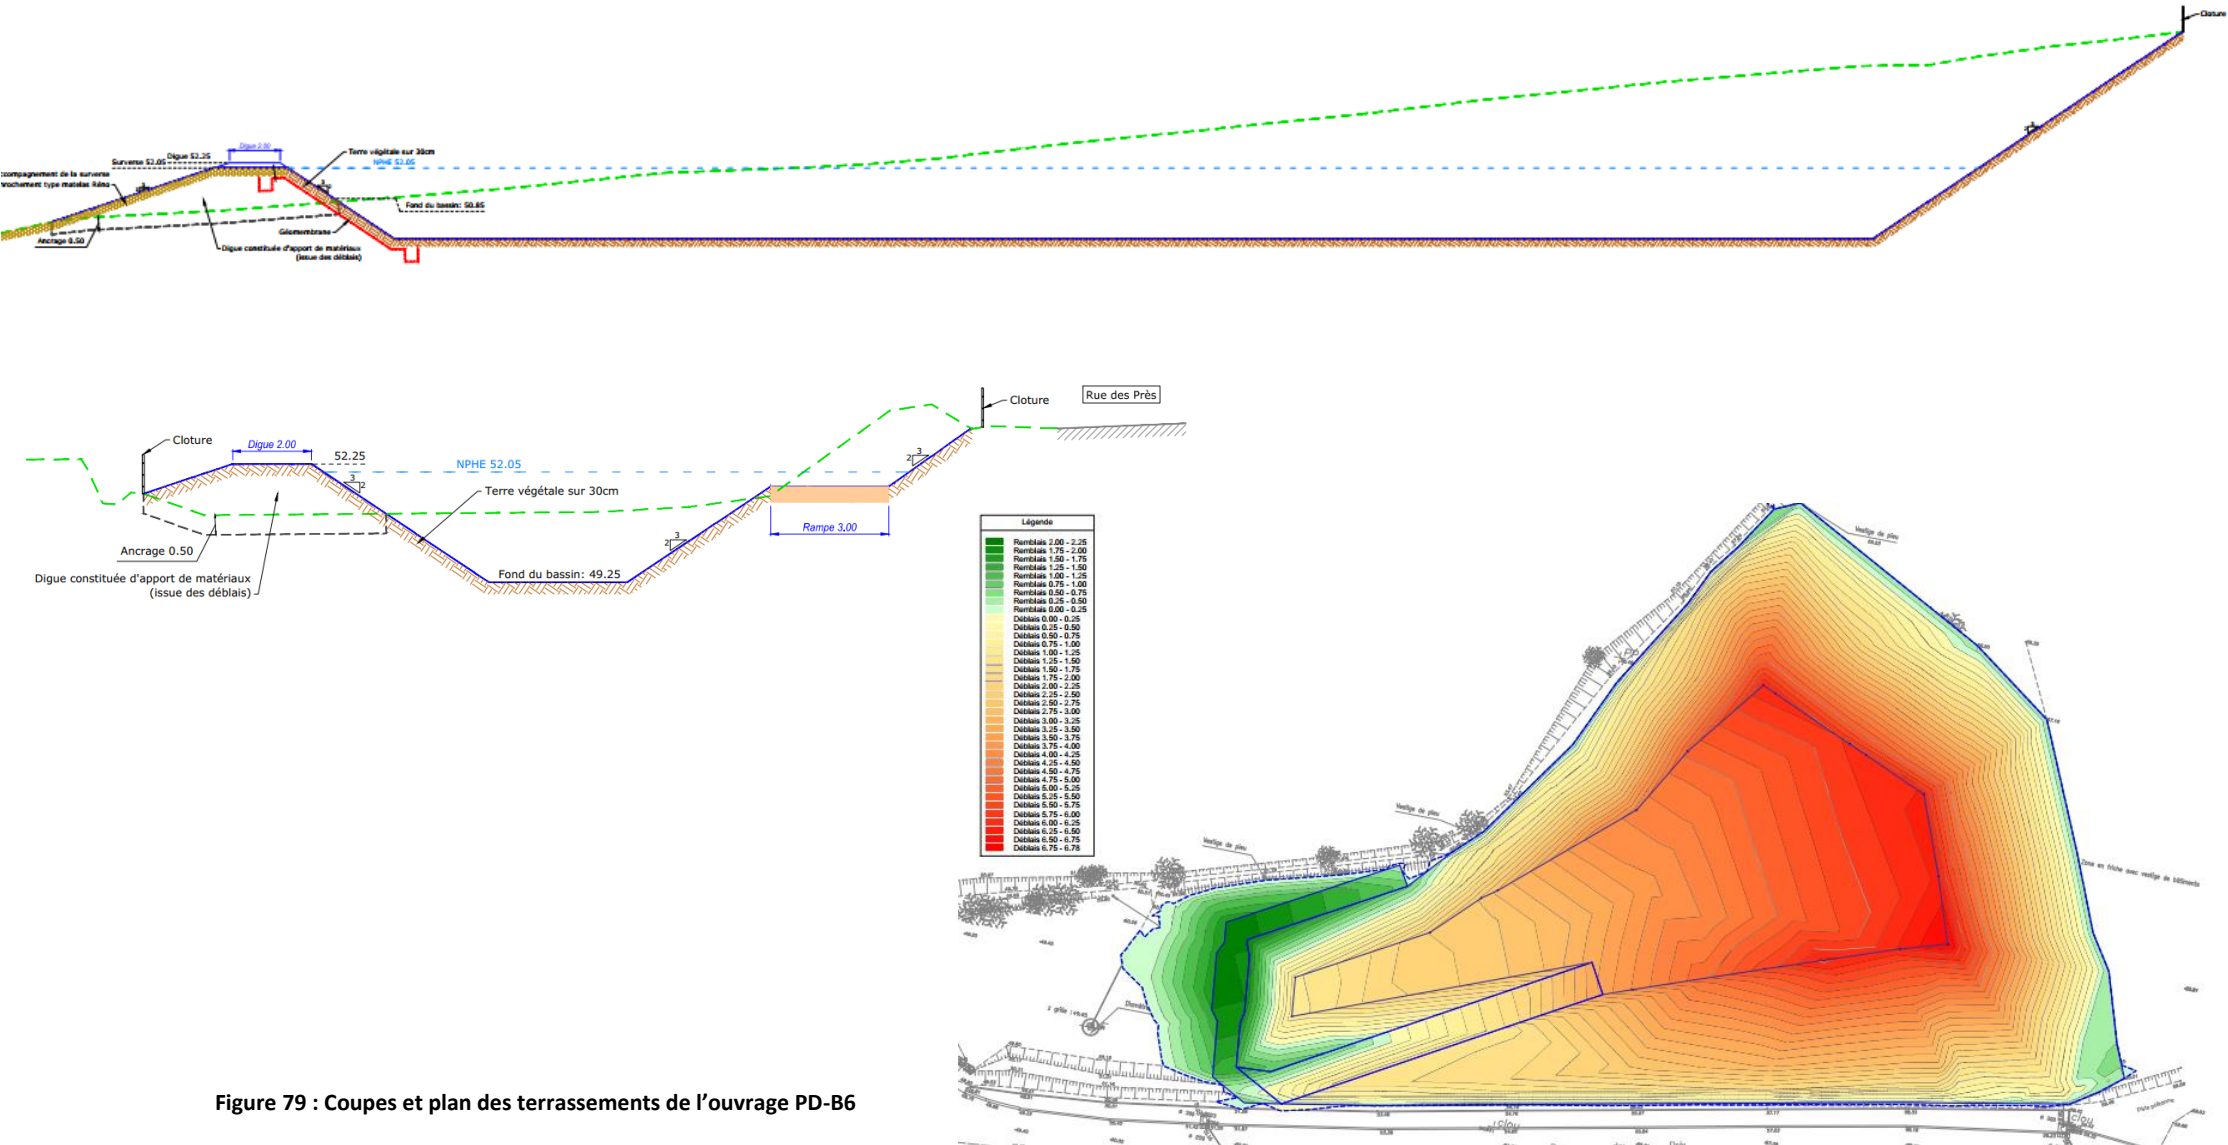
Coupes et plan des terrassements de l'ouvrage PD-B6
